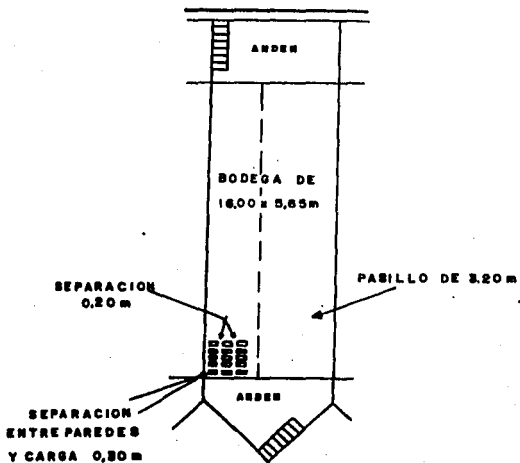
CROQUIS DE DIMENSIONES DE UNA BODEGA TIPO.
